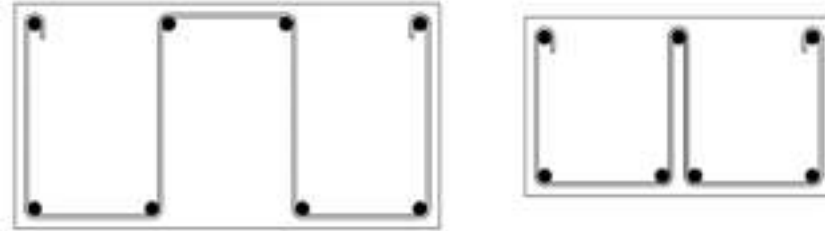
Disposición de estribos en vigas con ancho mayor a 40 cm
